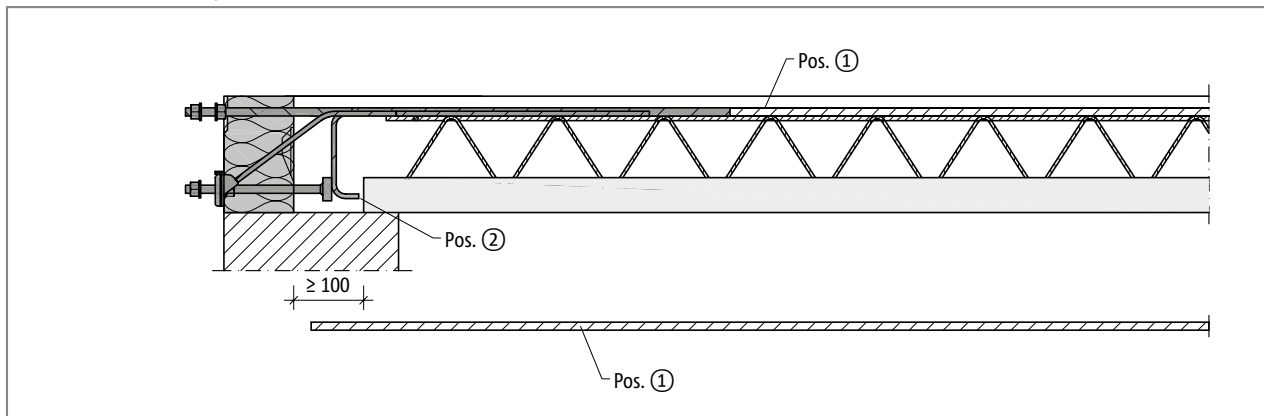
Schöck Isokorb® Typ KSXT14: Bauseitige Bewehrung bei Fertigteilbauweise, Schnitt
